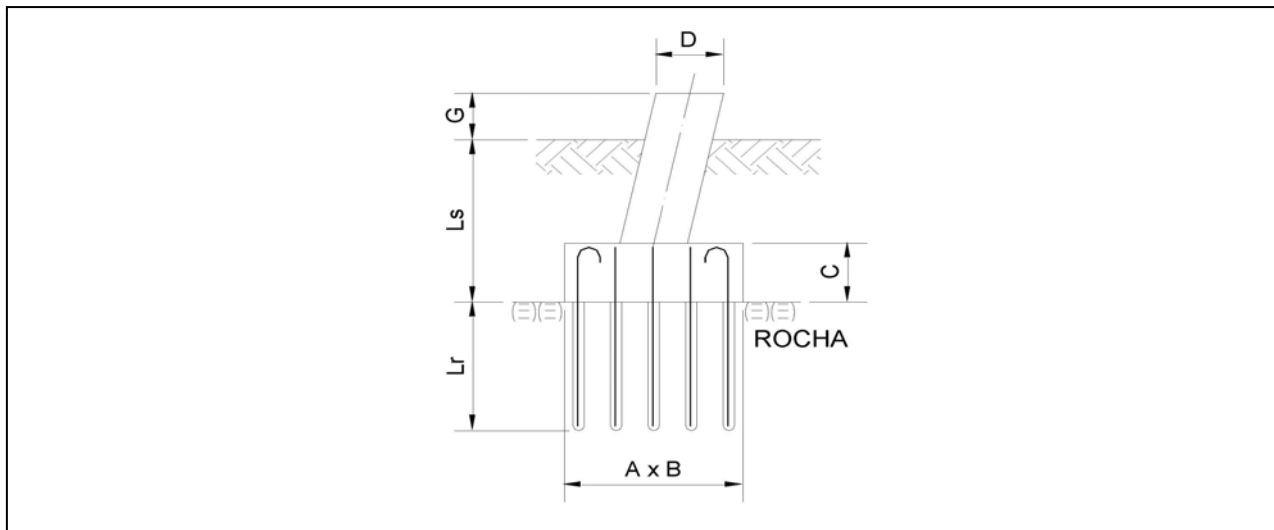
Fundação Tipo Bloco Chumbado em Rocha.
